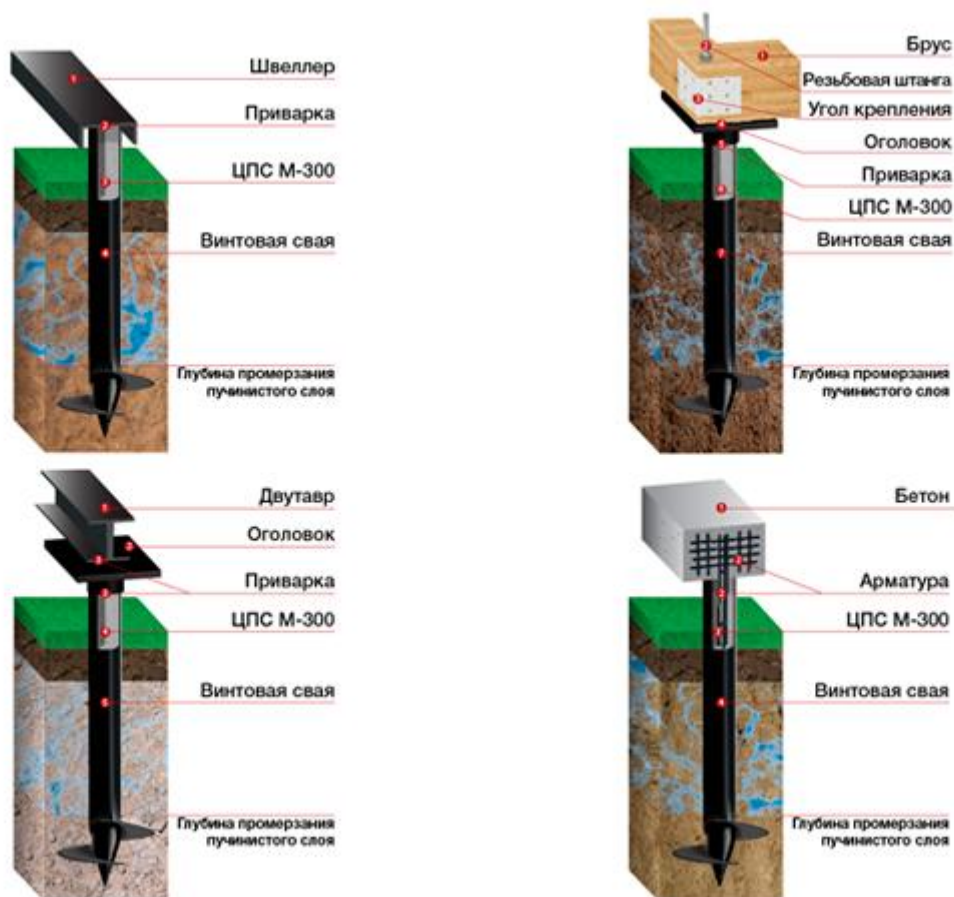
Крепление свай с оголовком швеллером, двутавром, брусом, железобетонным ростверком.
